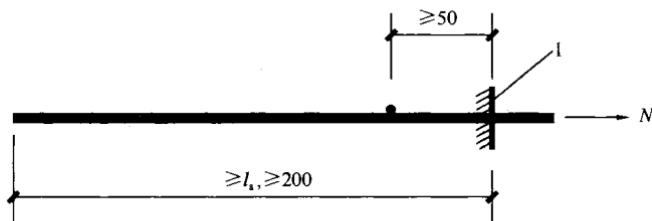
带肋钢筋焊接网纵向受拉钢筋的锚固
